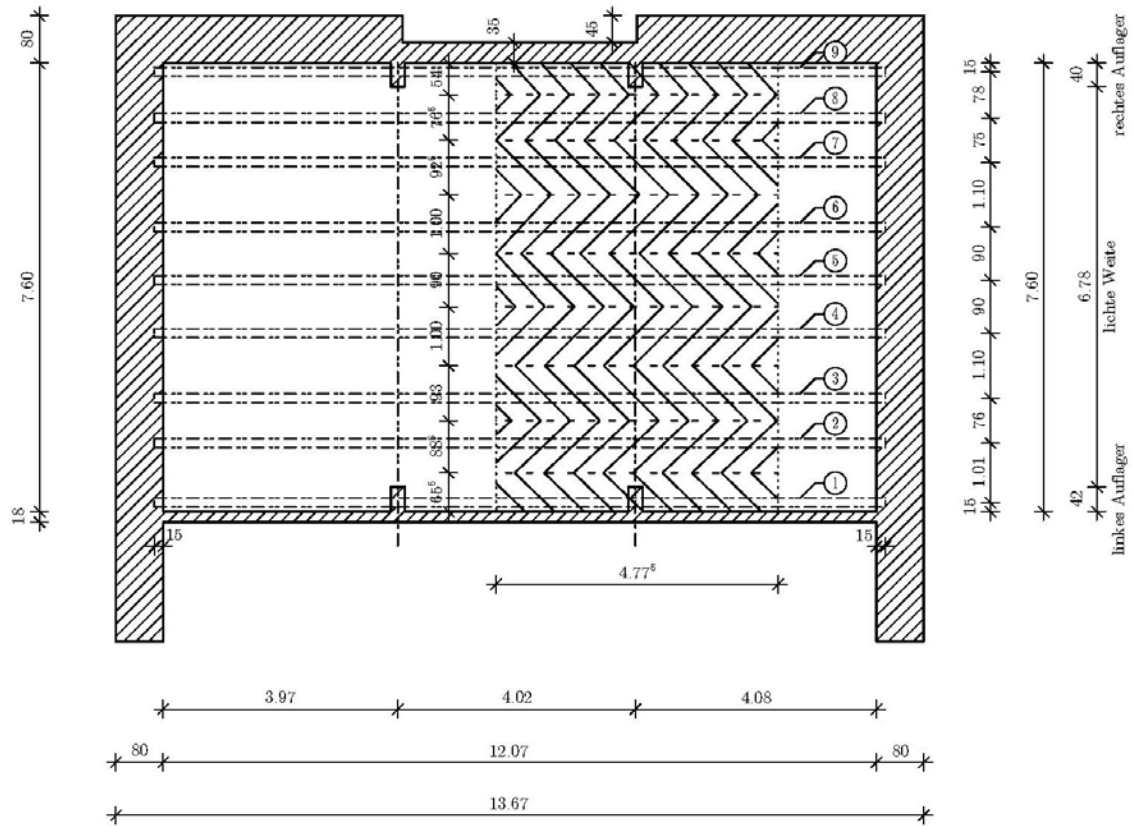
Grundriss 1. OG Bereich Hängewerk
